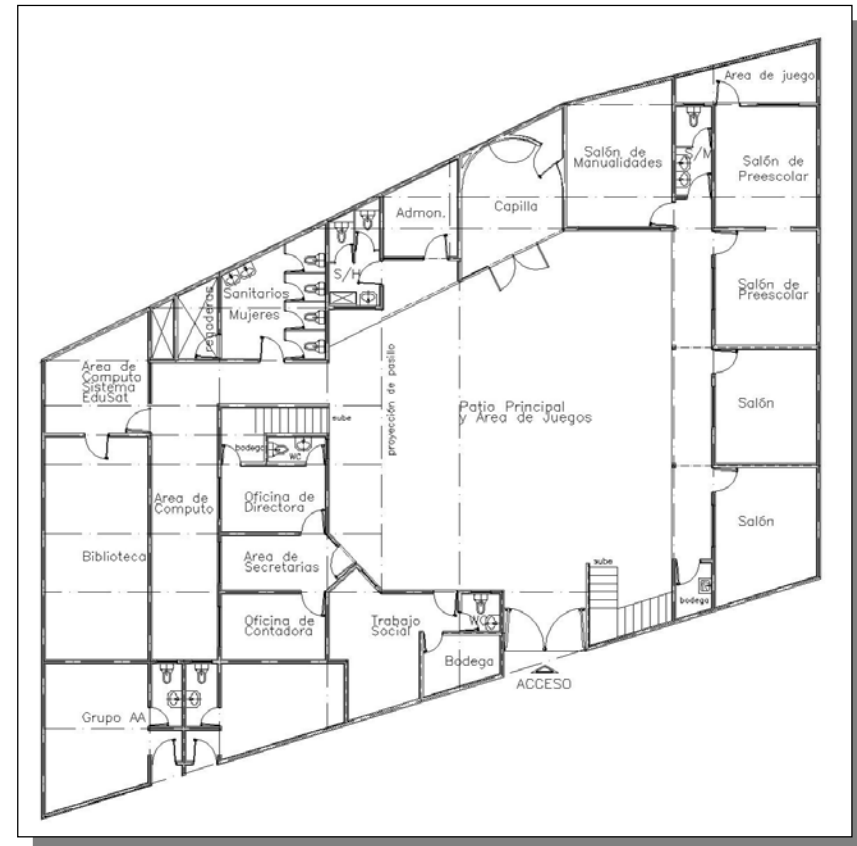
Planta baja edificio escolar y administrativo, PACO.
